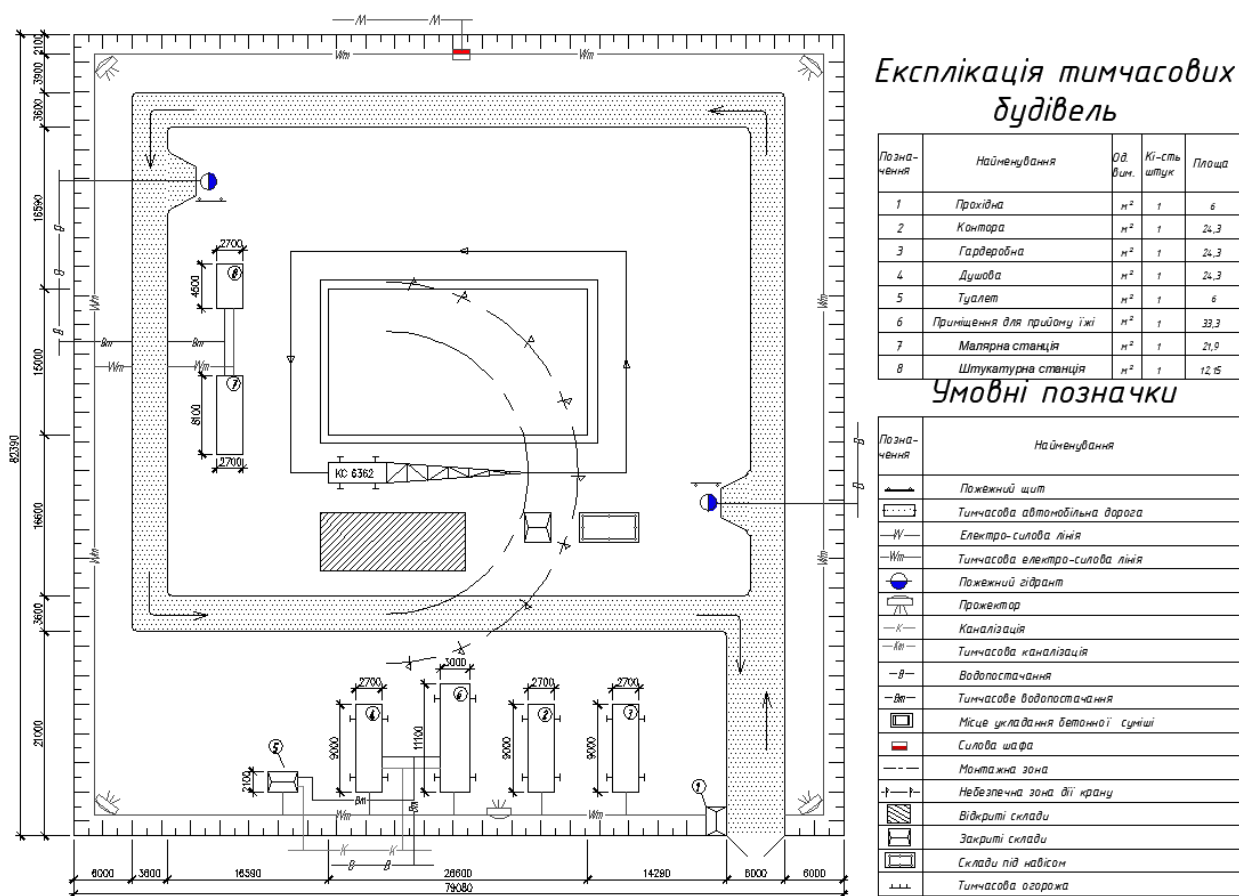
Схема генерального плану будівельного майданчику
